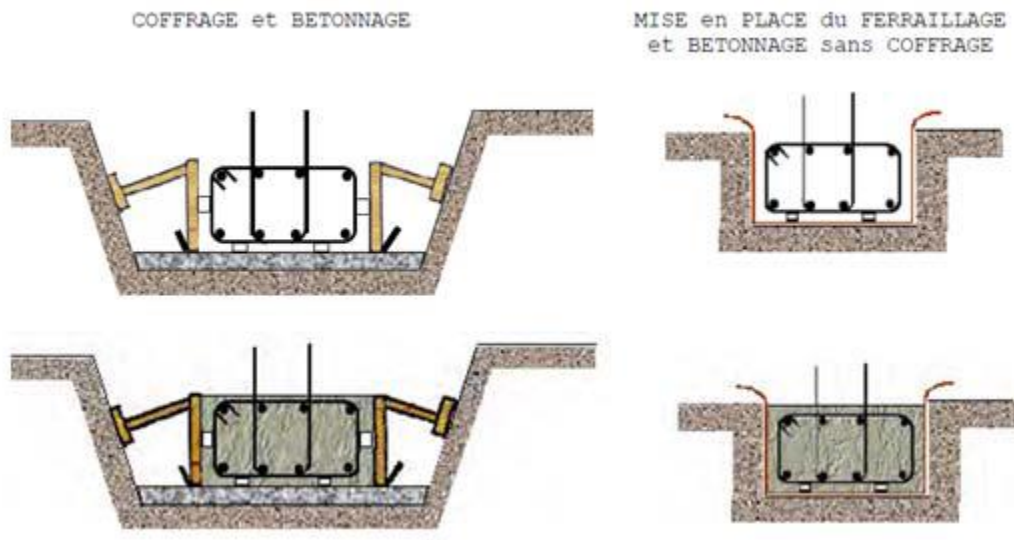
Bétonnage avec coffrage et bétonnage en pleine fouille
